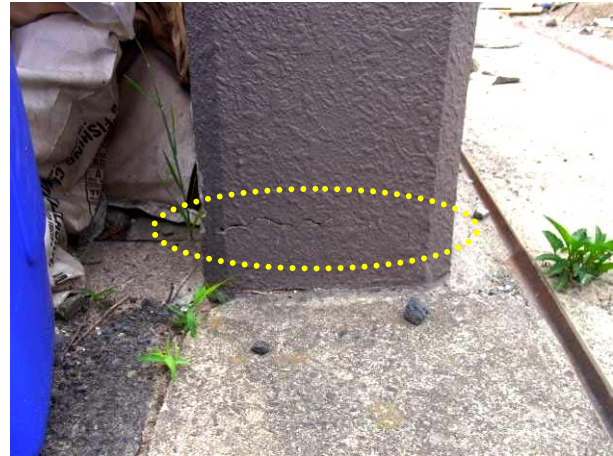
RC 塀脚部に生じた曲げひび割れ
